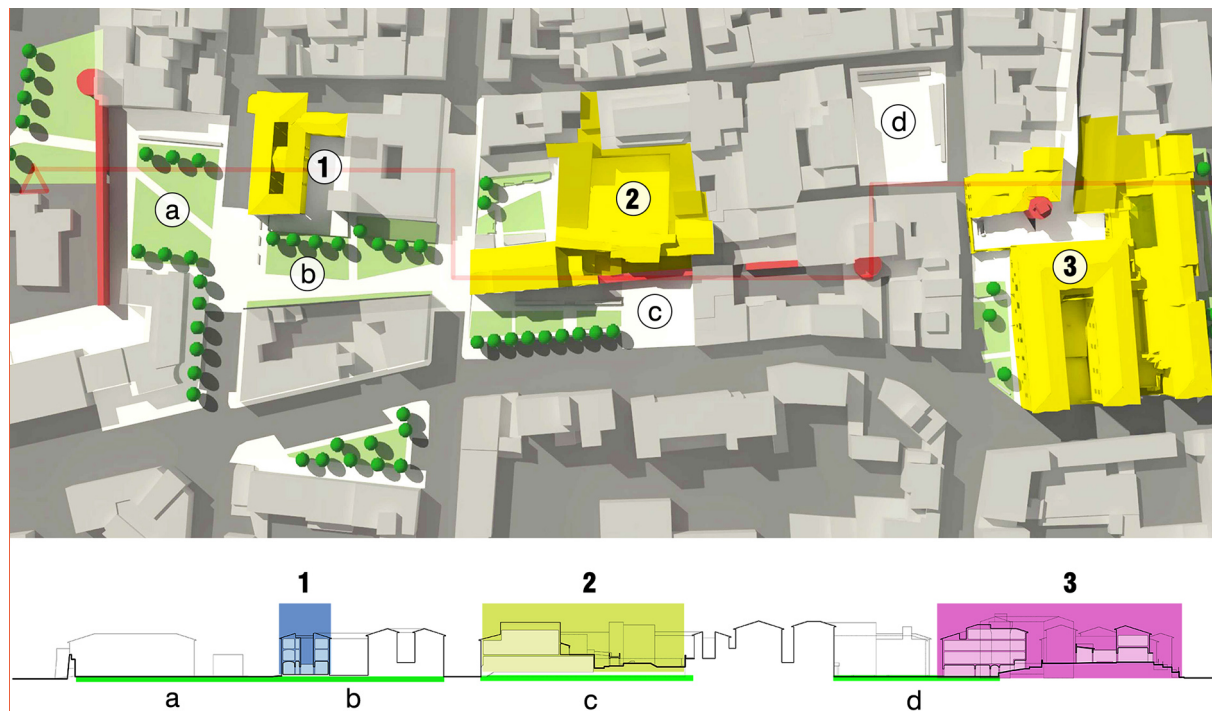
| Planivolumetrico e sezione ambientale del progetto, con evidenziati i tre complessi edilizi oggetto d'intervento (in giallo), gli spazi pubblici da riqualificare (in bianco) e il tracciato ancora visibile delle mura cittadine (in rosso). Nel dettaglio: complesso di P.zza XXIV Luglio (1), ex convento degli Agostiniani (2), complesso di San Giuseppe (3), P.zza XXIV Luglio (a), Giardino di Largo della Resistenza (b), Giardino della biblioteca (c), P.zza del popolo (d).
